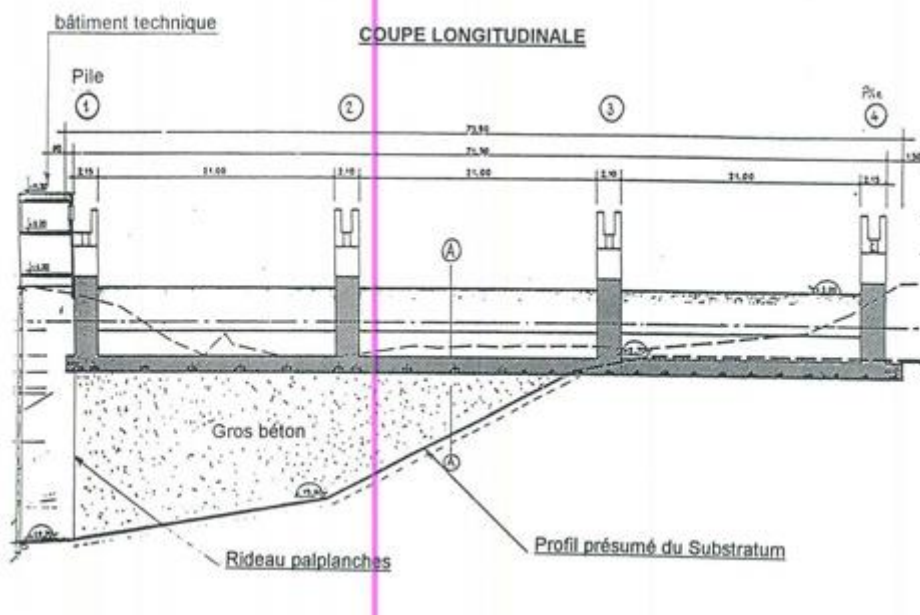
Coupe longitudinale du barrage de Pont Rousseau (source : EPALA)
